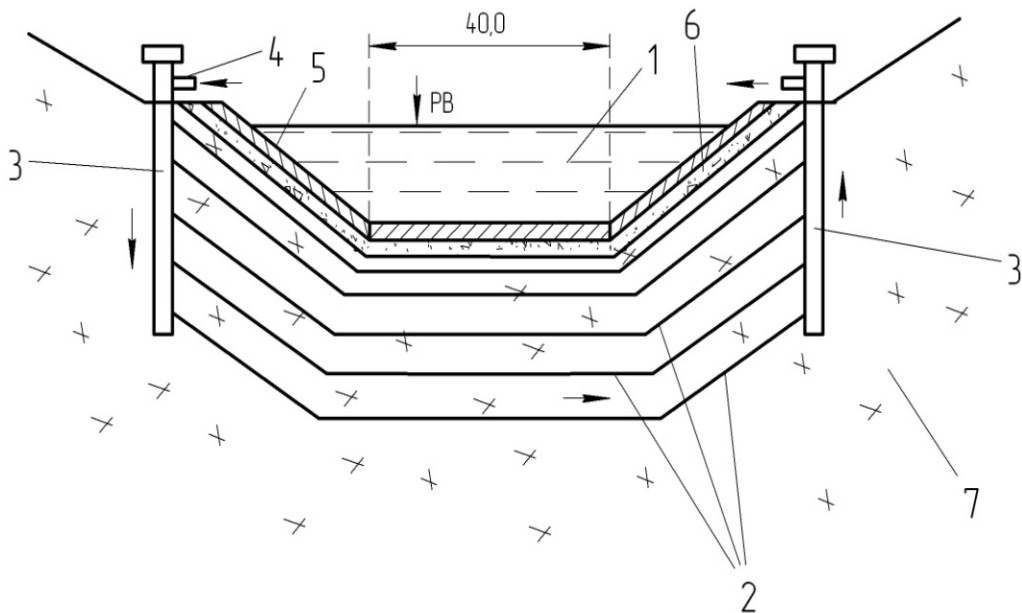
Схема заморожуючої системи під водоскидним каналом водоскиду гідровузла Ірелях: 1 – канал, 2 – заморожуючі труби, 3 – колектор, 4 – вентилятор, 5 – залізобетонні плити, 6 – щербинь, 7 – напівскельні ґрунти
